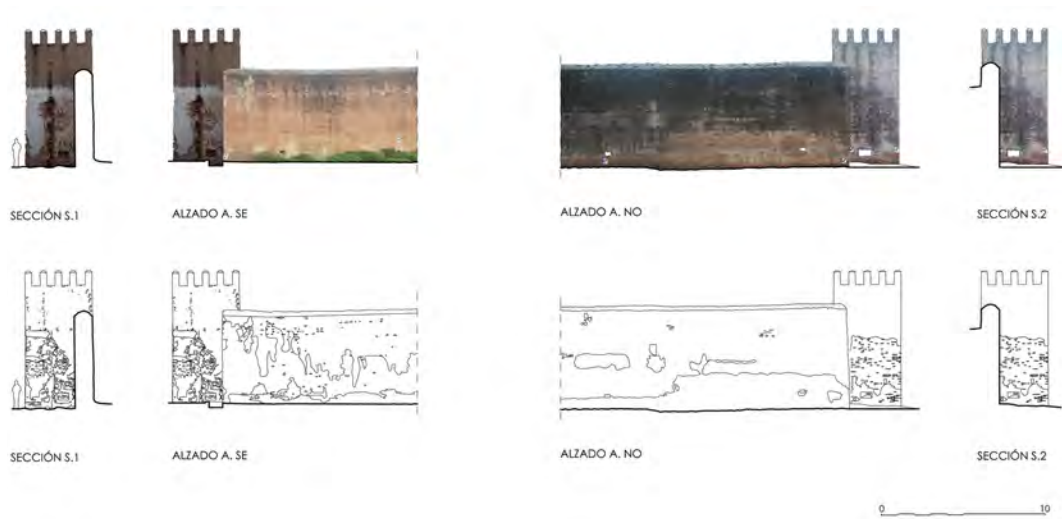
Muralla de Mascarell. Secciones alzado suroeste. Fuente: P. Rodríguez-Navarro y T. Gil Piqueras.
